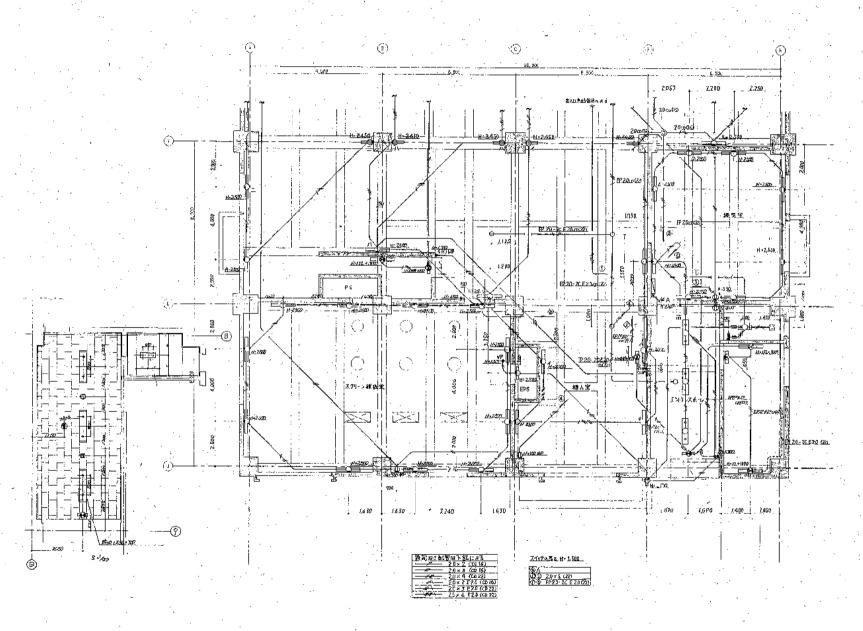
汚泥濃縮棟 B 1 階平面図 図番 3
